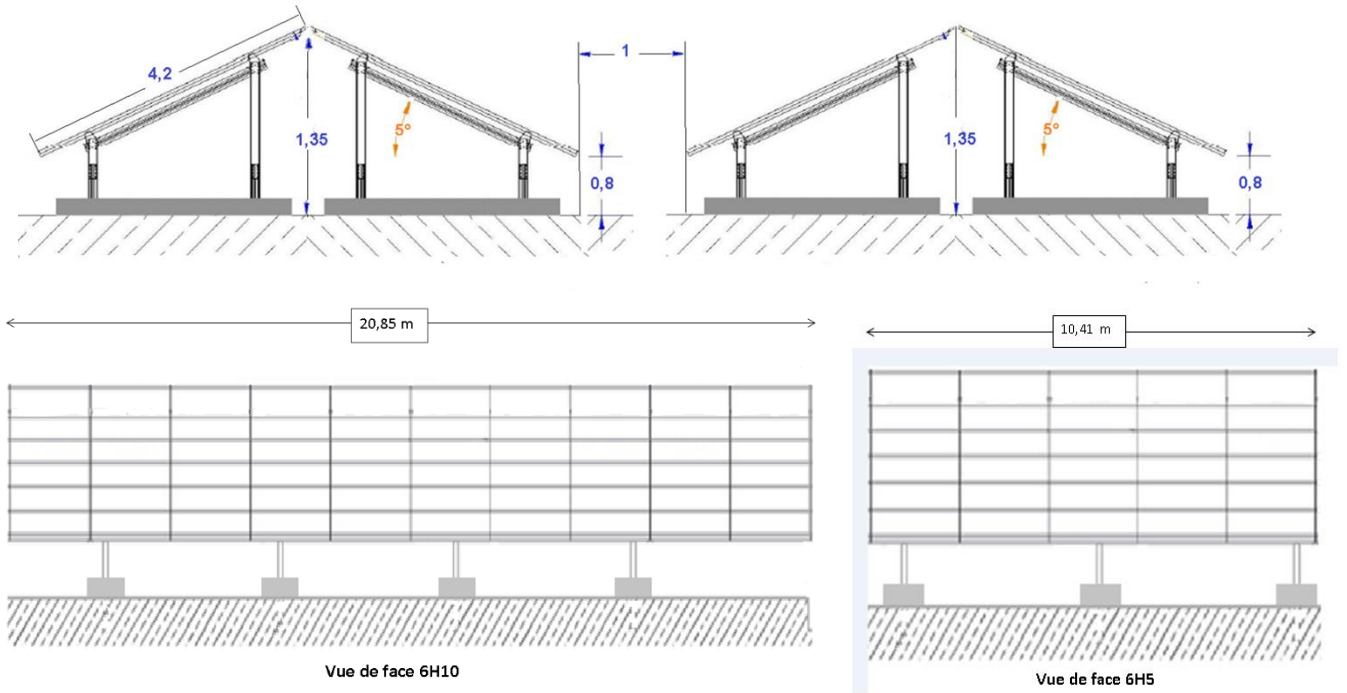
Vues de face et en coupe des tables Grand et Petit formats sur longrines
